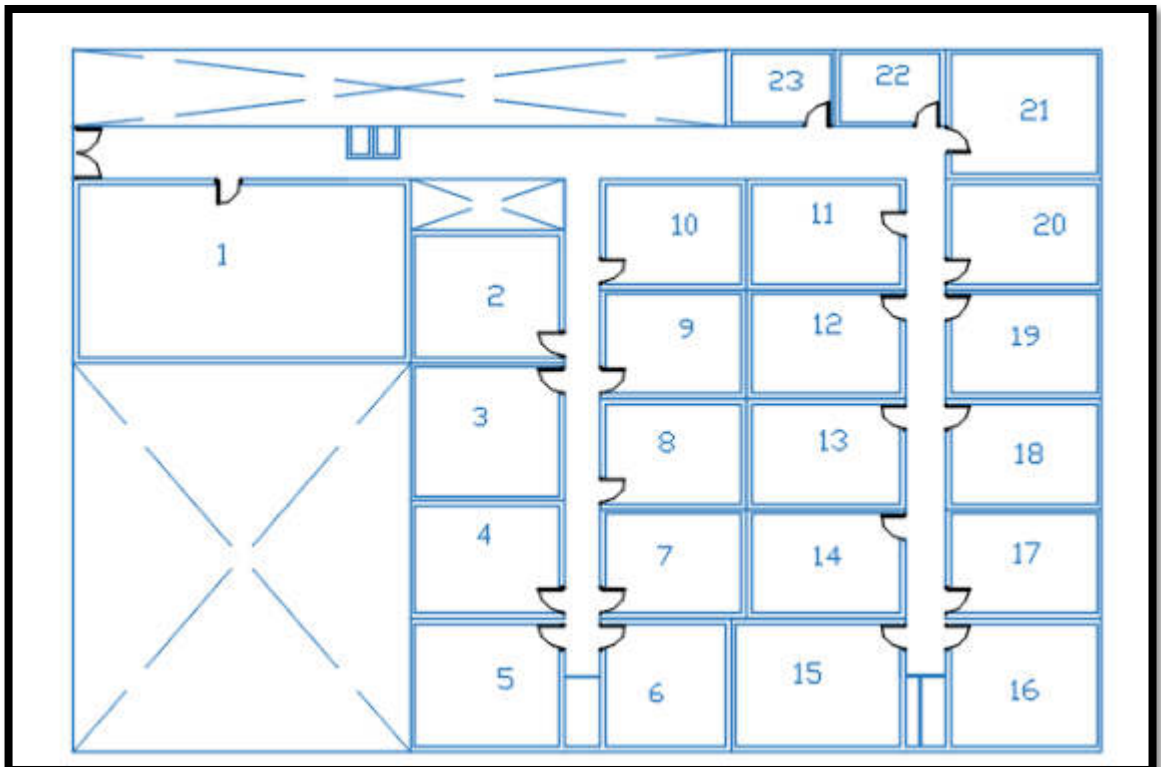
Plano de las viviendas de la quinta Los Virreyes del Rímac
